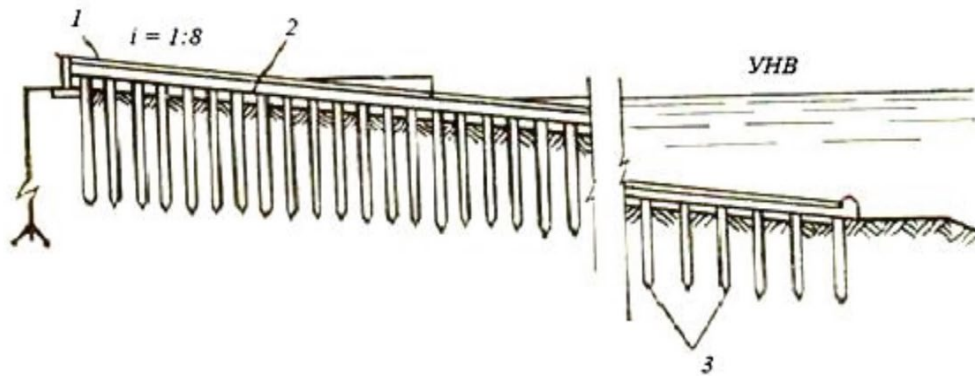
Нерозрізні залізобетонні балки на палях:
